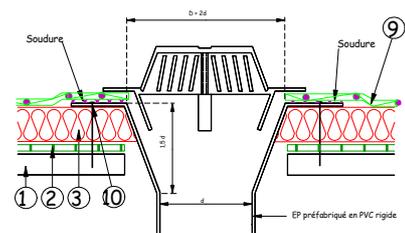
Entrée d'eau pluviale préfabriquée en PVC
